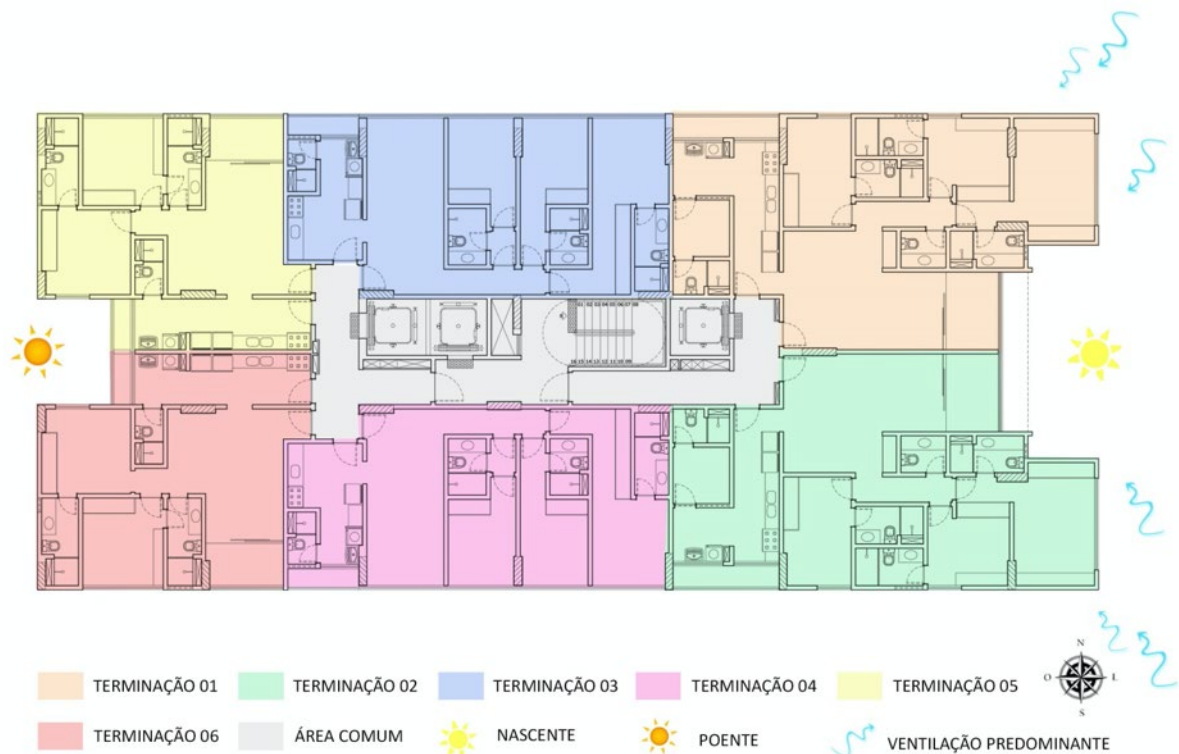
Planta baixa do pavimento tipo do edifício Marine Park
